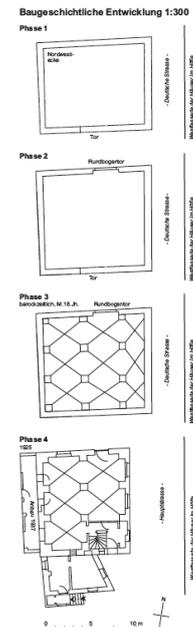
Grundrisse 1:300 mit Darstellung der Bauphasen.
